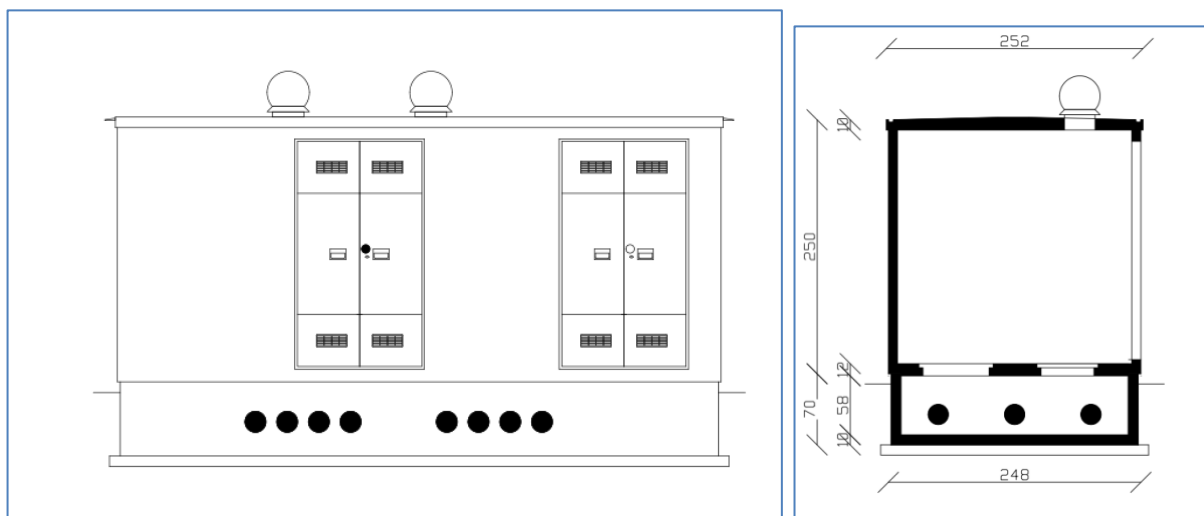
Prospetto lato strada e sezione tipo della cabina di sezionamento con posizionamento su vasca di fondazione
